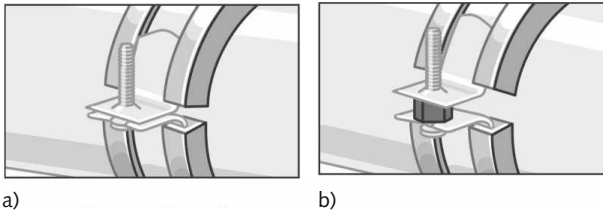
a) Collier serrant pour créer un point fixe ;
